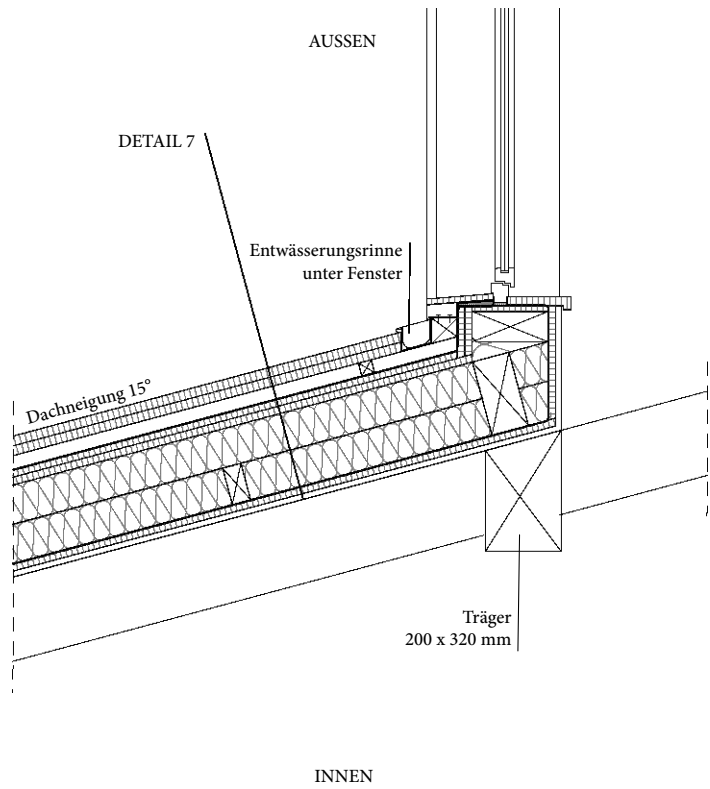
| Detail Dachanschluss-Fenster. Hand|Werk|Raum. M1:20.
